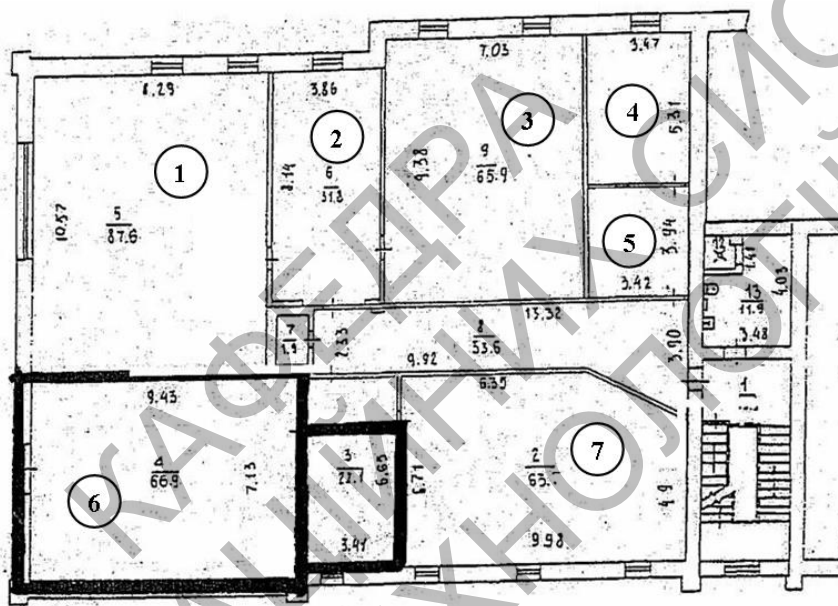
План поверху офісної будівлі за варіантом №
